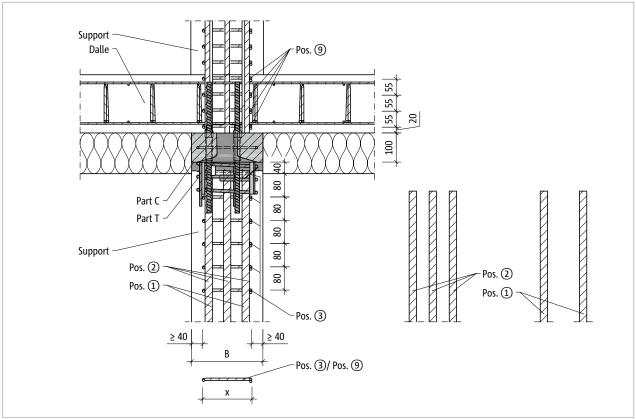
Schöck Sconnex® type P : renforcement sur site dans la coupe longitudinale A-A du poteau
